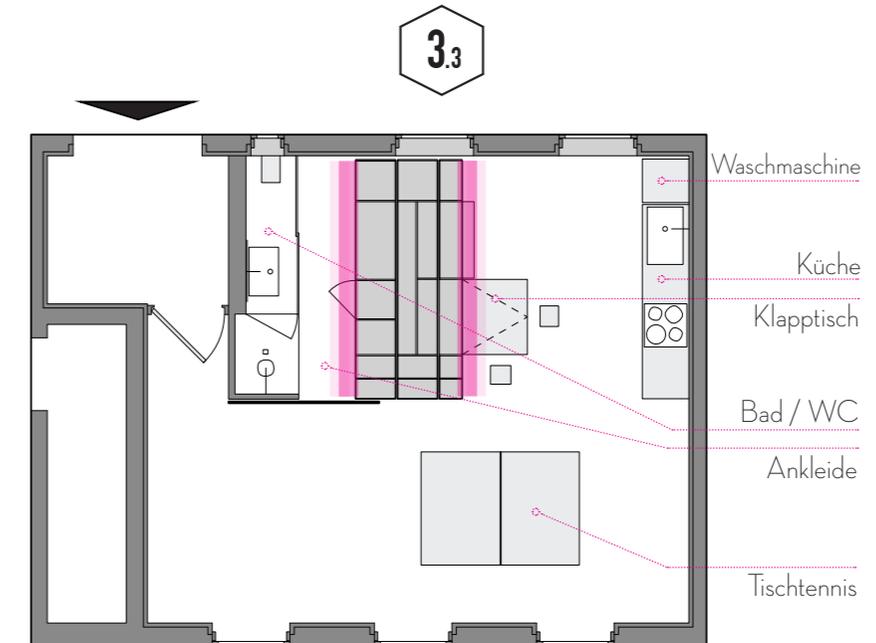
Grundriss:: Komplett, Ausführung mit Küche und Badeein-
